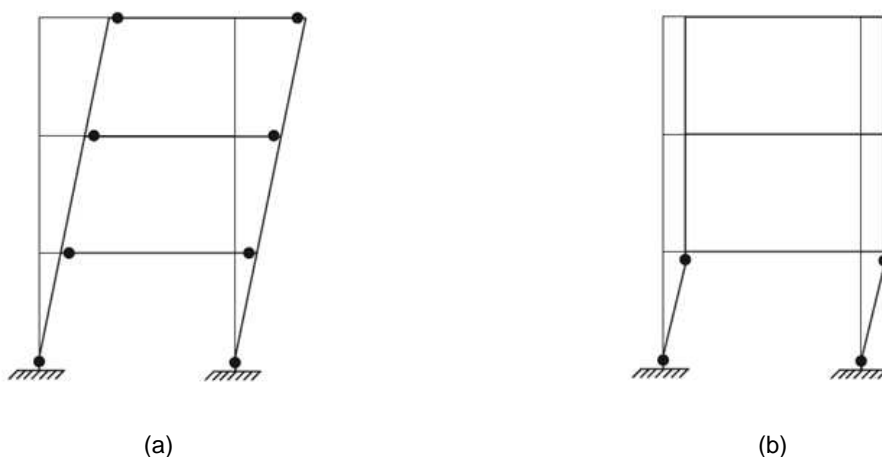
Comportamento de pórtico de ligações rígidas com comportamento de pilar forte viga fraca (a) e pilar fraco e viga forte (b)
